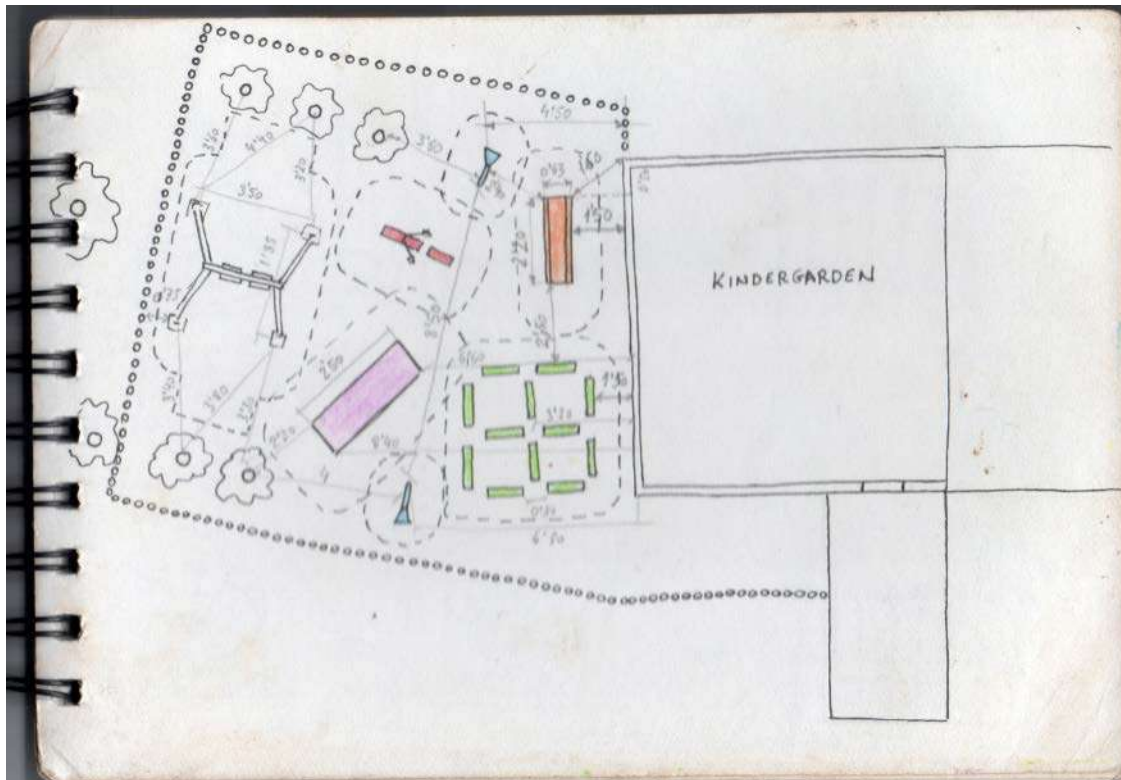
Boceto de elementos distribuidos en el terreno del kindergarten. Elaboración propia
